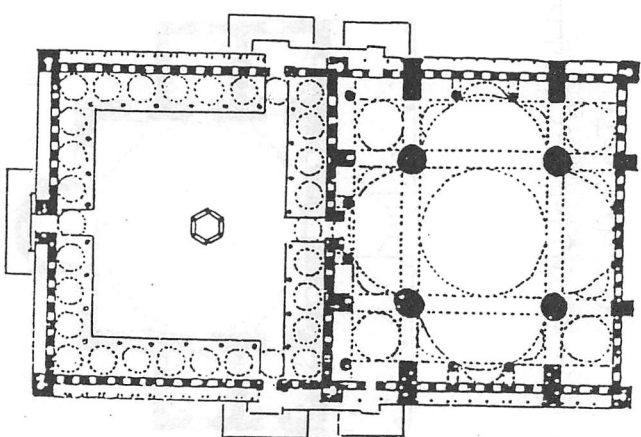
المسقط الأفقي لجامع السلعيدانية بإستانبول .
